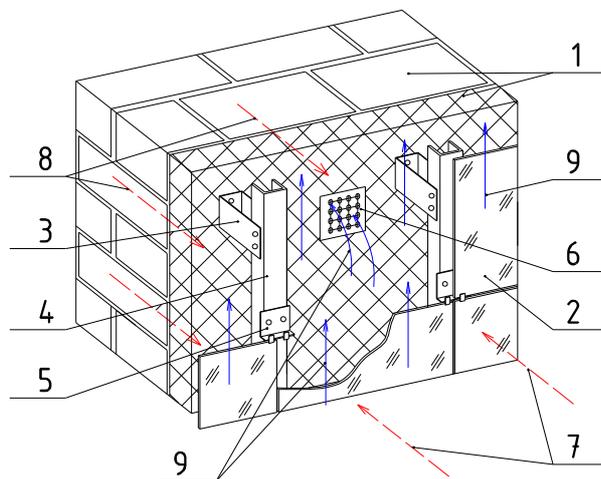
Схема конструкции фасада здания с рекуперативными приточными вентиляционными блоками, тепловых и воздушных потоков в конструкции:
